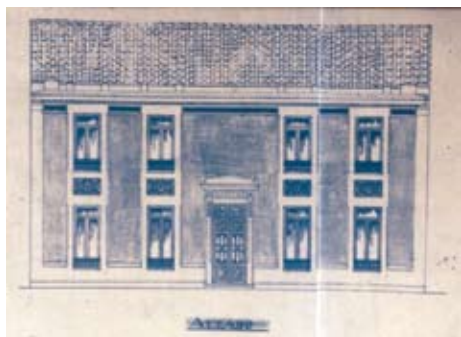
Alzado Barrio de San Ildefonso, 1924.
